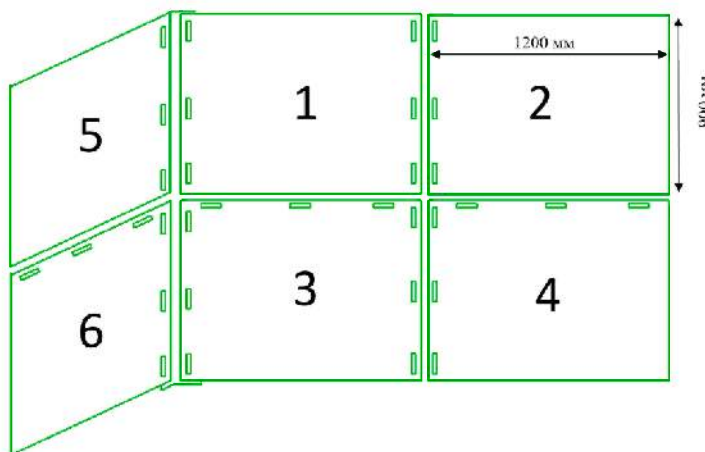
Собранная конструкция из щитов опалубки с внешними углами
